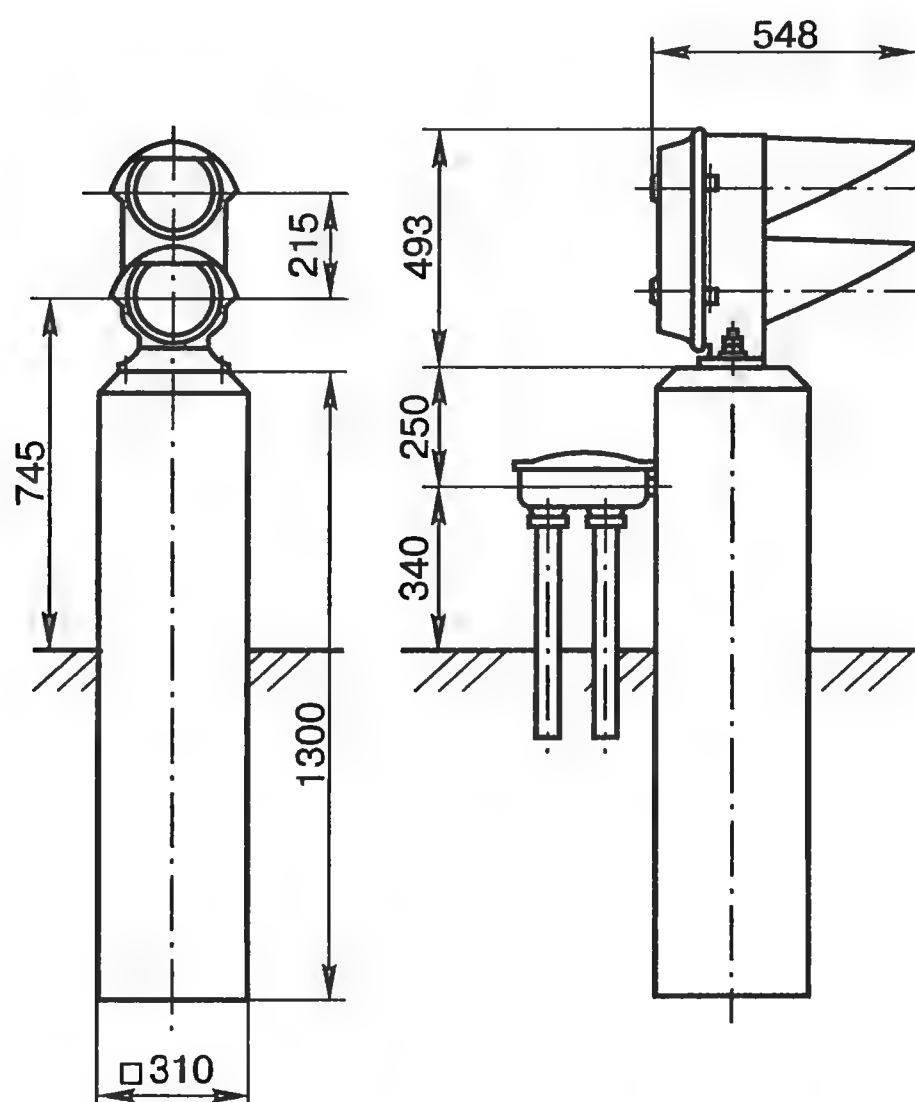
Двузначный карликовый светофор на железобетонном фундаменте
